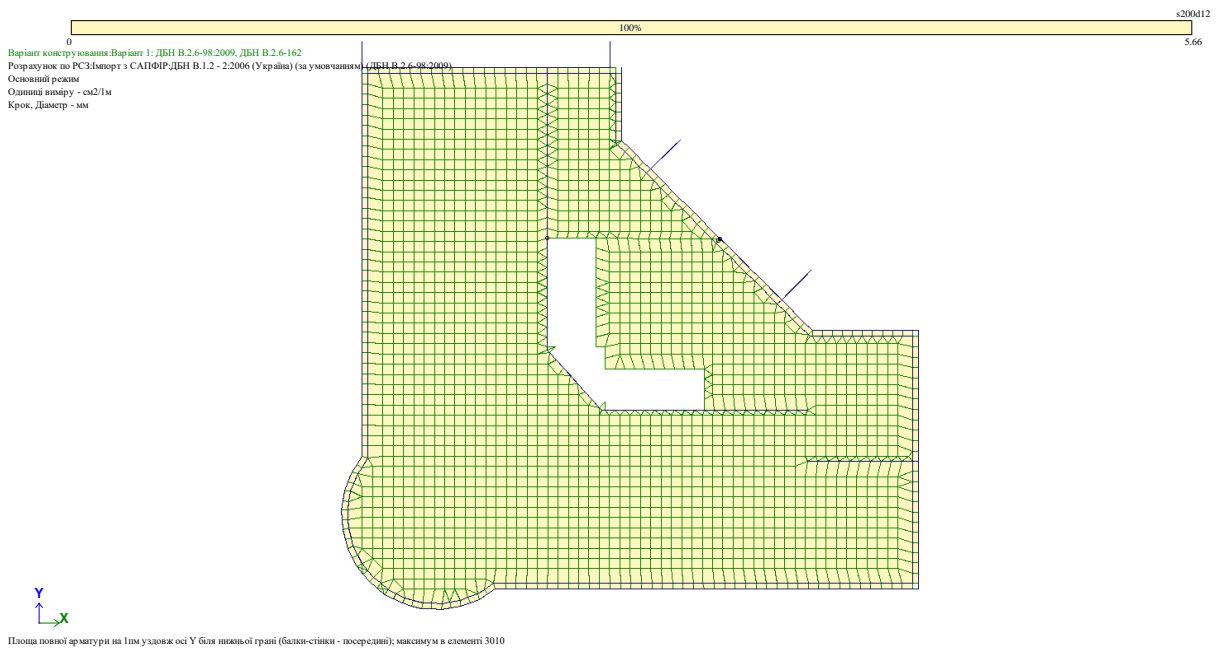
Площа повної арматури на 1пм уздовж осі Y біля нижньої грані (балки-стілки - посередині) для плити перекриття цокольного поверху
